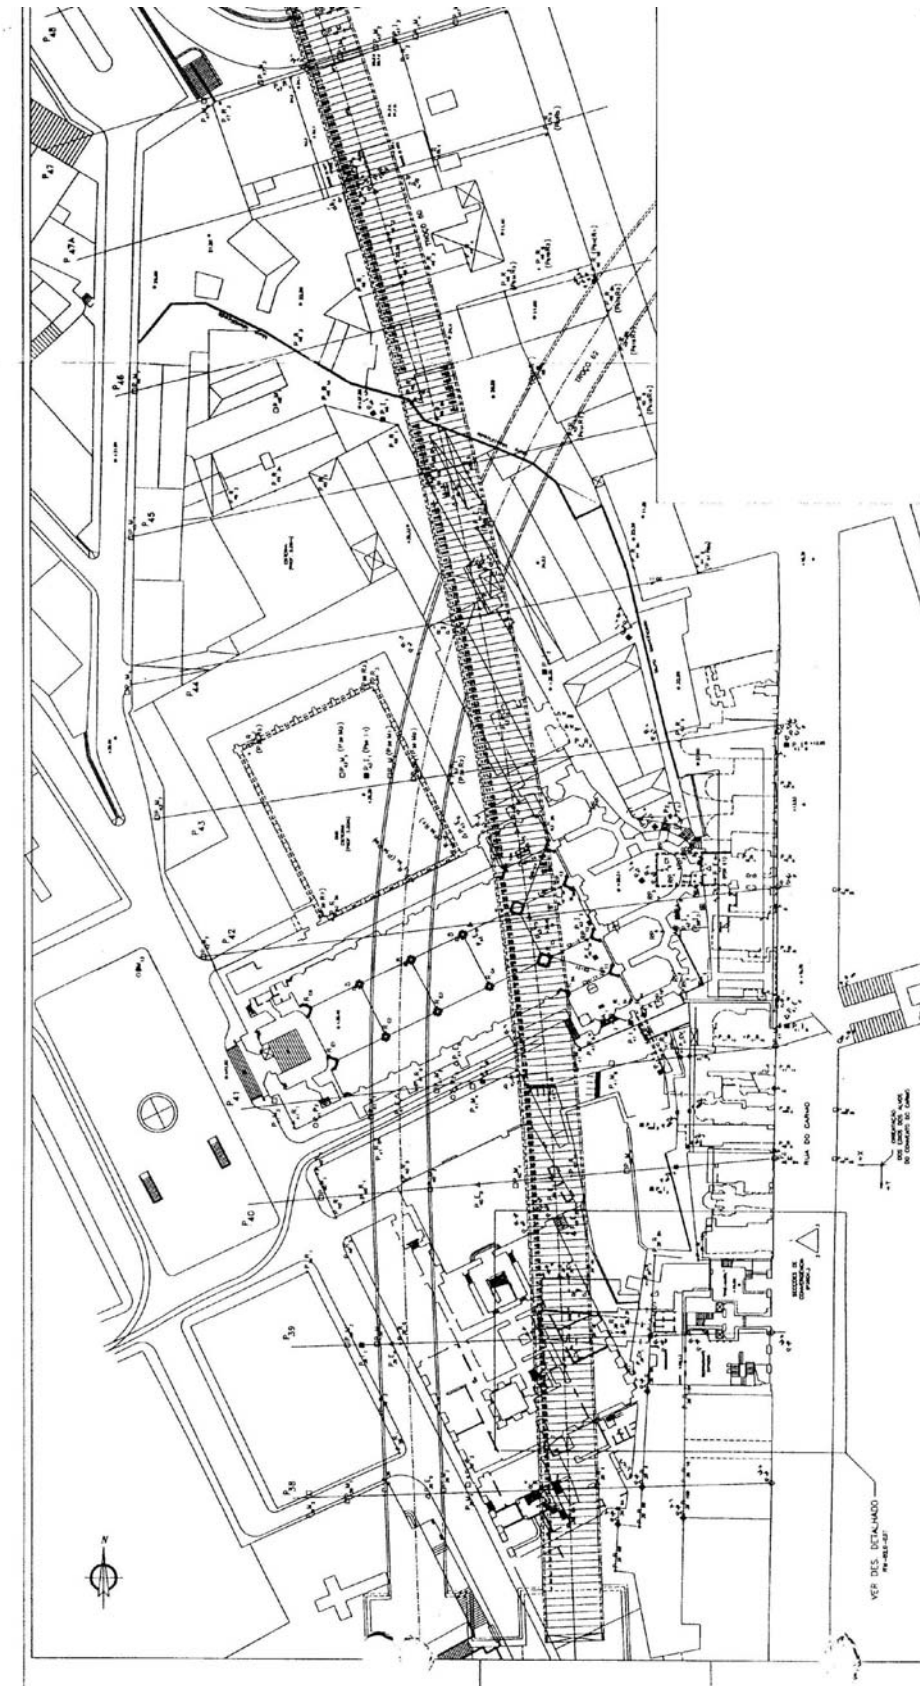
Planta de localização da instrumentação do troço 60 – Baixa/Chiado – Restauradores.
